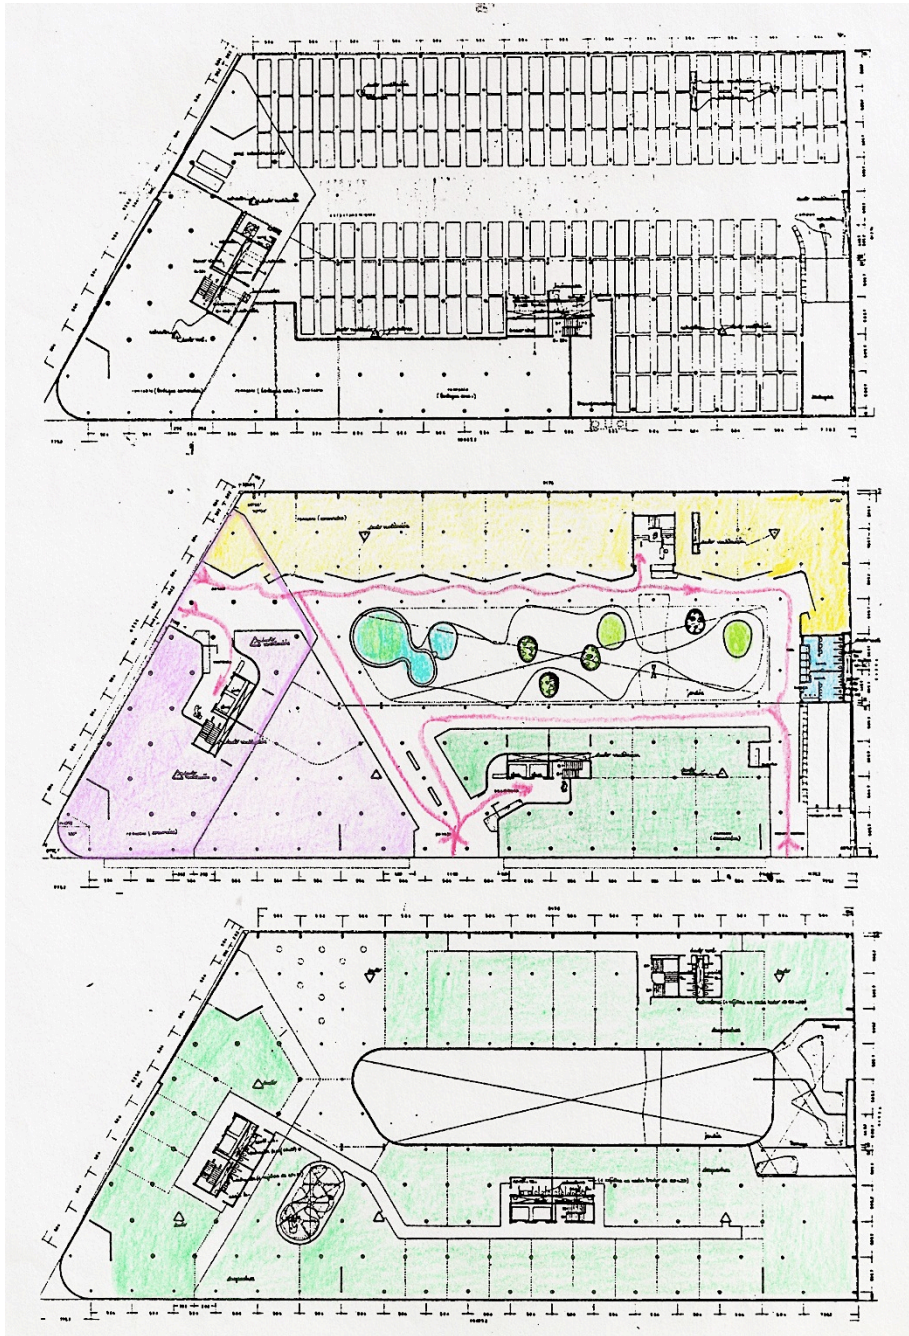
Edificio Aristos, Plantas arquitectónicas y estacionamiento; en planta baja en color rojo se muestra los recorridos hacia el patio interior que eran públicos y se podía atravesar este edificio, ahora ya no es posible; y planta tipo en color verde, puede observarse que cada cuerpo es independiente y tienen sus propias circulaciones verticales, que se comunicaban entre sí.
